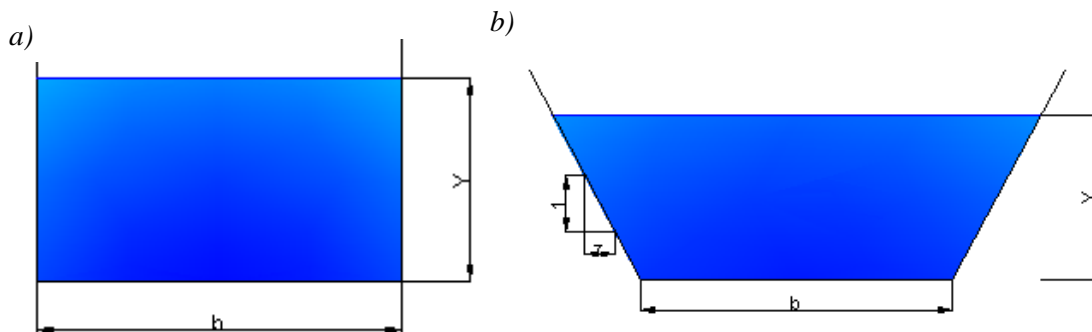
Muestra de secciones de canales a) sección cuadrada b) sección trapezoidal
